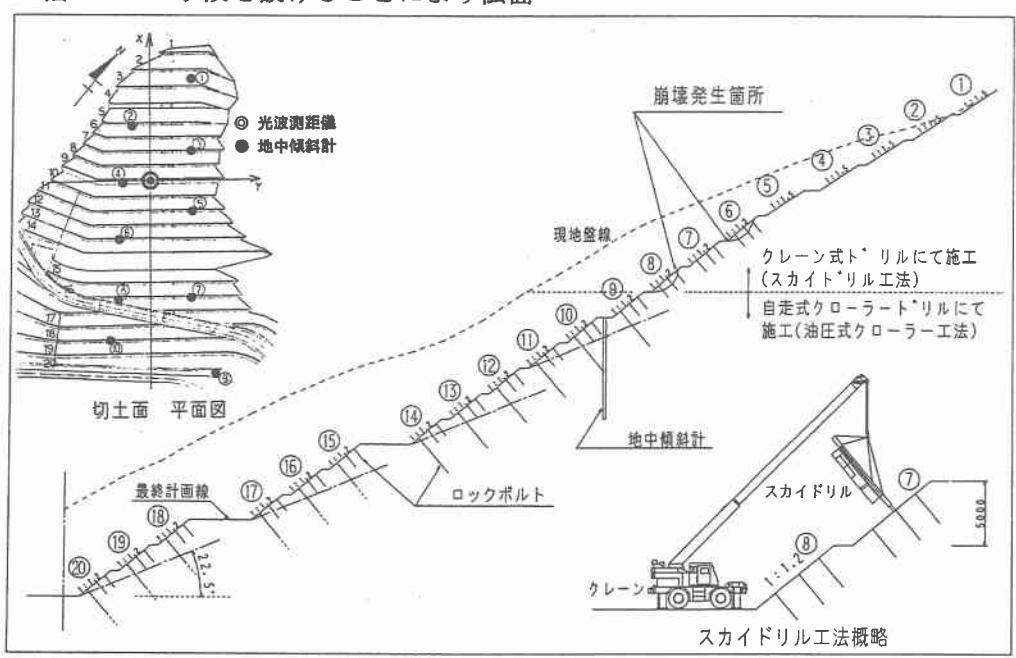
長大切土法面の断面図、平面図およびスカイドリル工法の概略図
